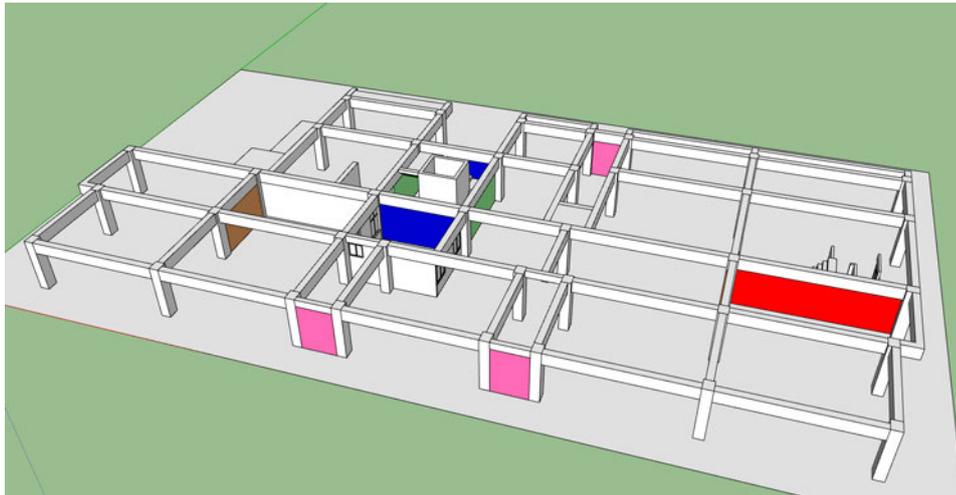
案例二階段性補強A補強位置示意(一樓)
